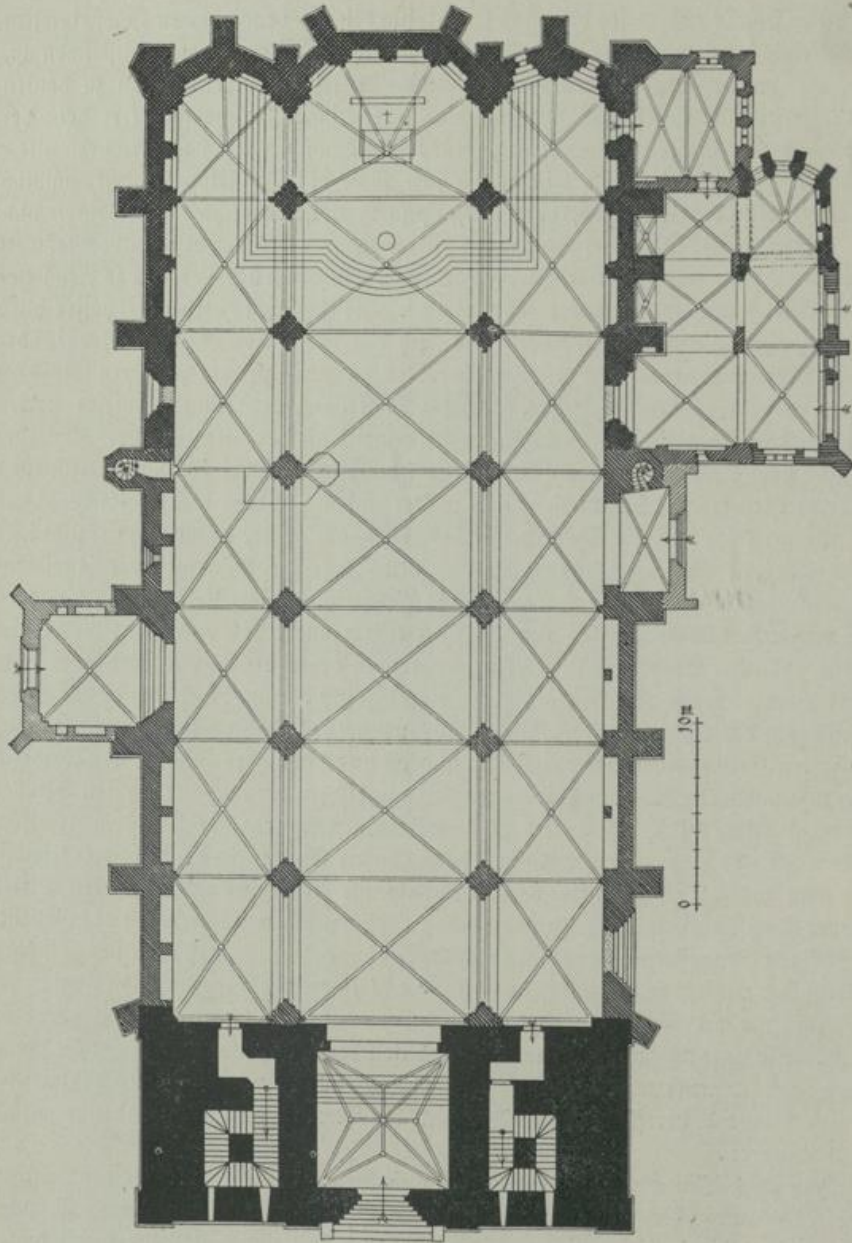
Prenzlau. Marienkirche. Grundriß im Erdgeschoß.
